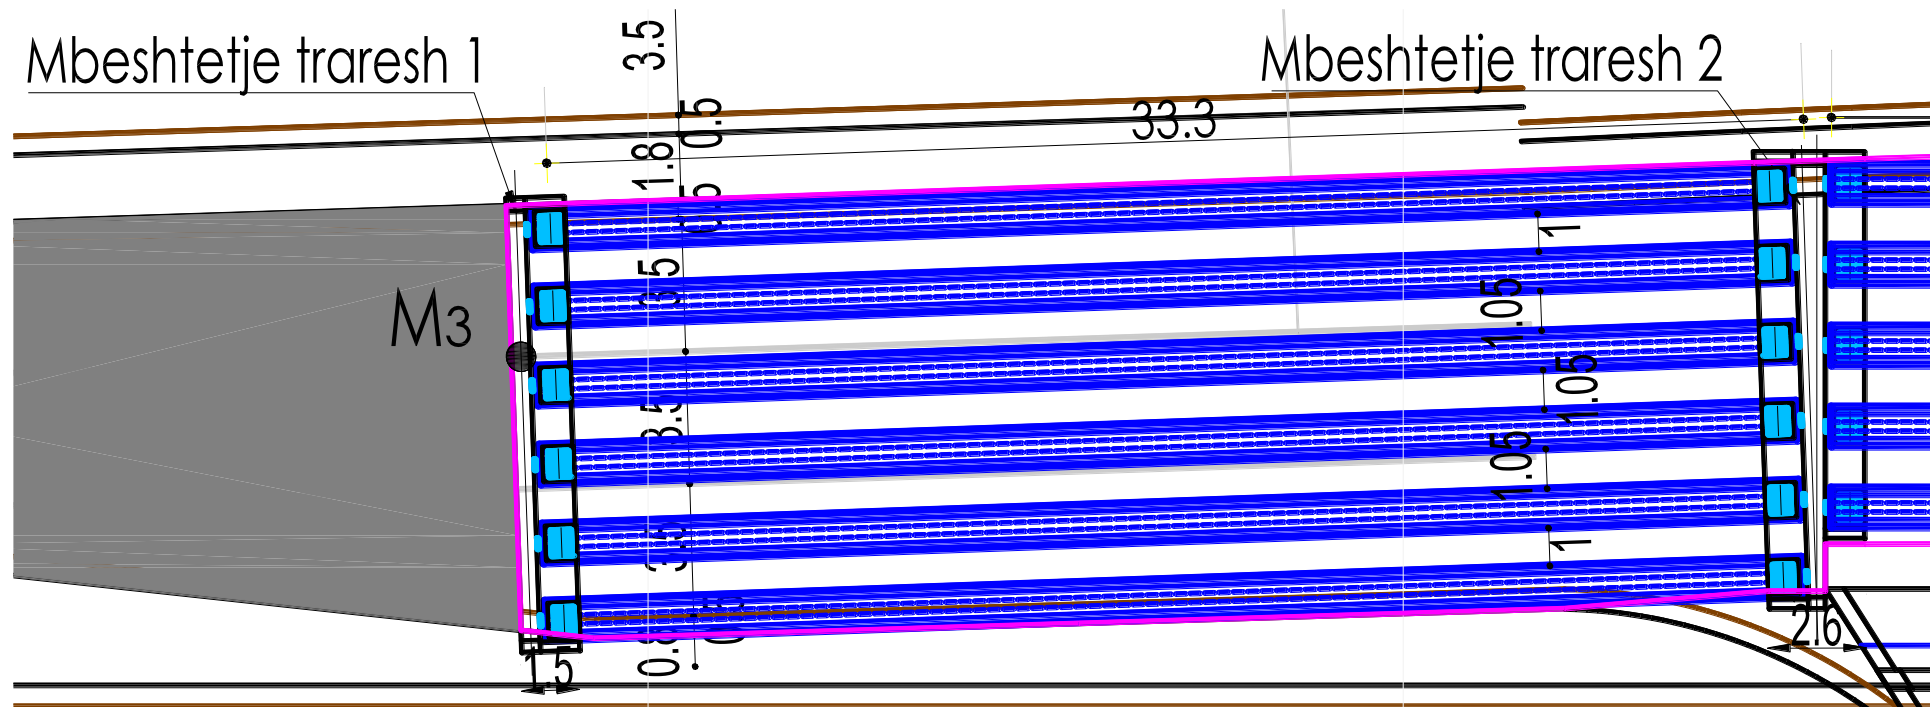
Pjesë planimetrie - Strukturat e LOT 3 - Struktura M3
